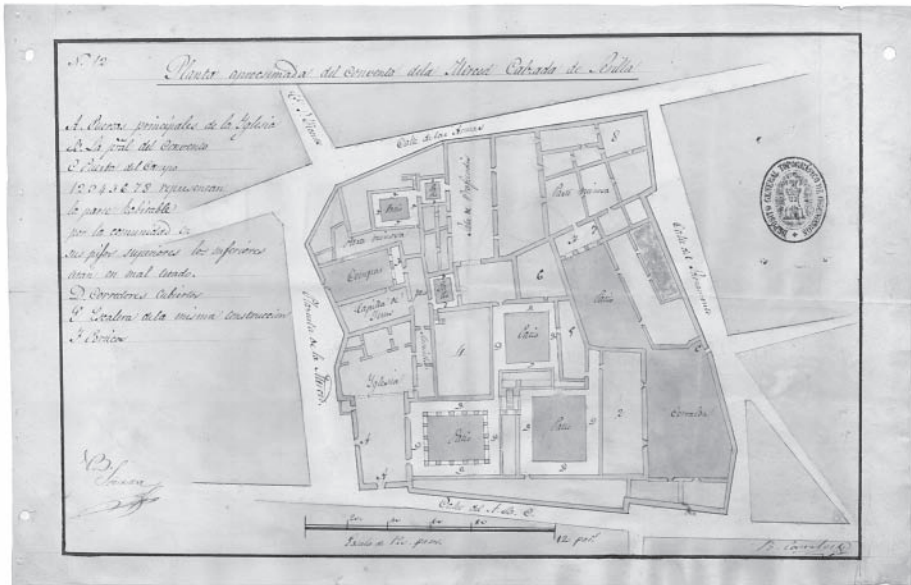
B. León y Canales. Planta del convento de la Merced Calzada de Sevilla. 1835 (AGMM).
